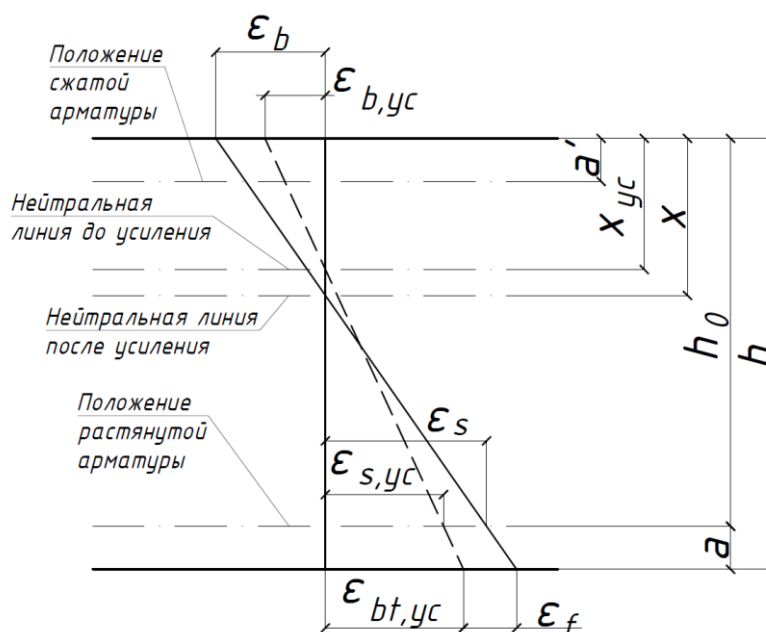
Распределение продольных деформаций для железобетонного элемента, усиленного внешним композитным армированием (разработано авторами)
